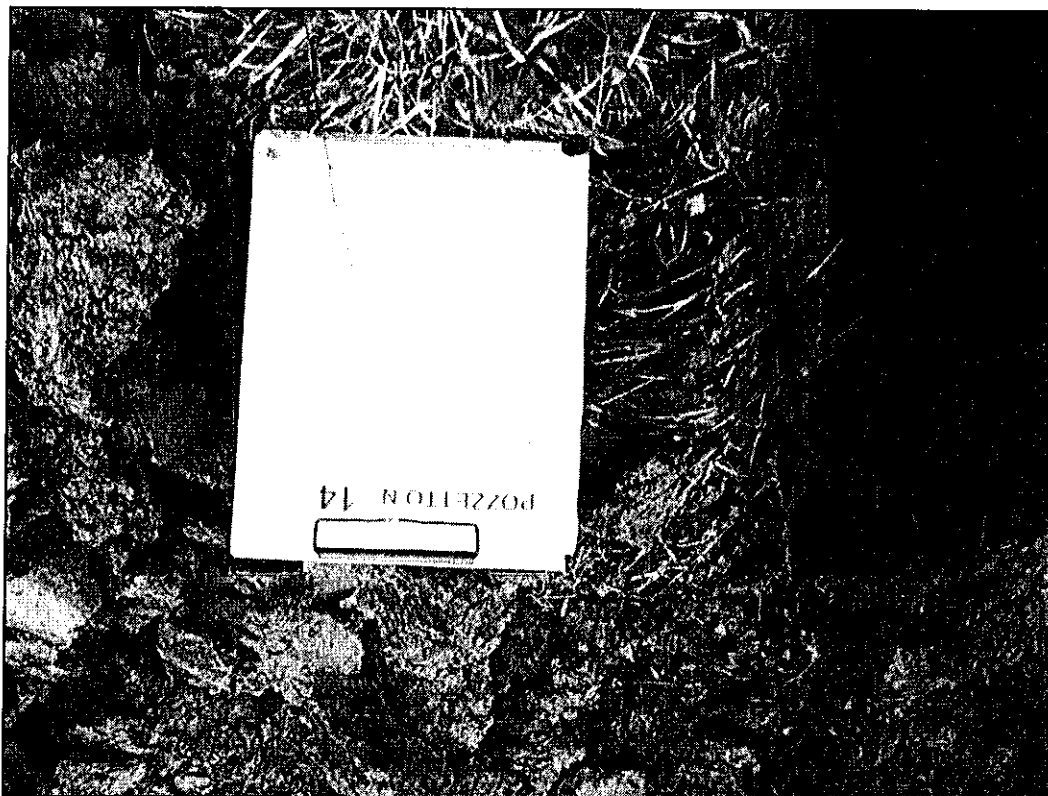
Pozzetto n° 14. Profondità -1,5 m dal p.c.
